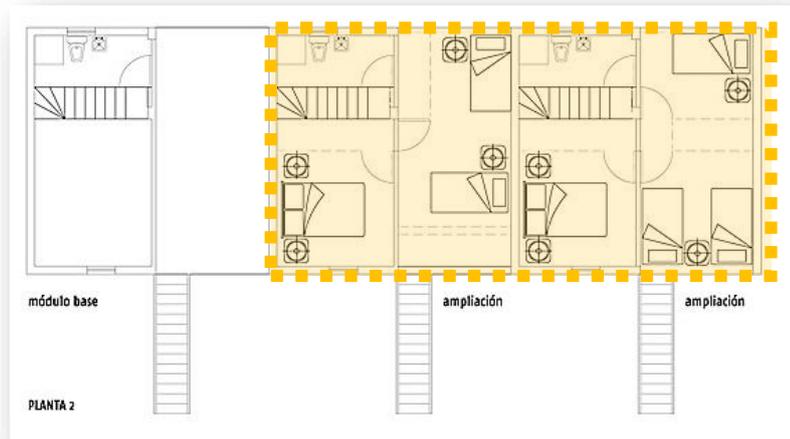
Planta Típica Vivienda Tipo B - 2do nivel
